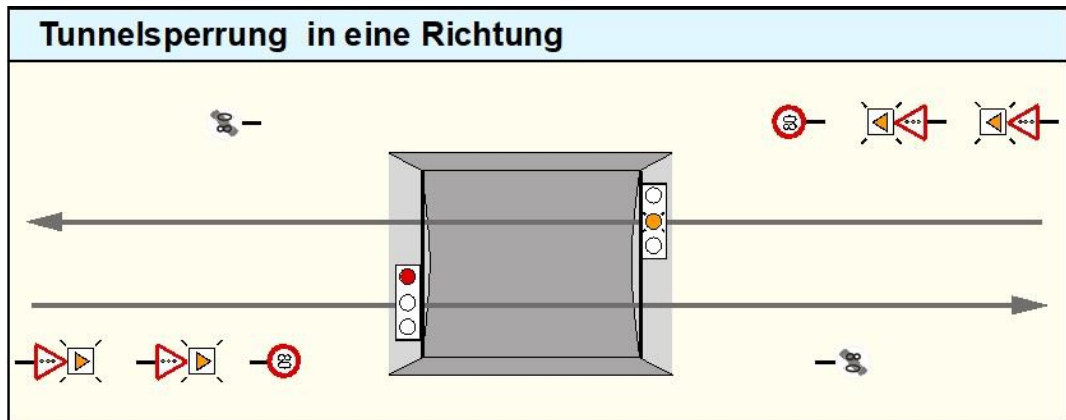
BZ – Tunnelsperrung in eine Richtung.
